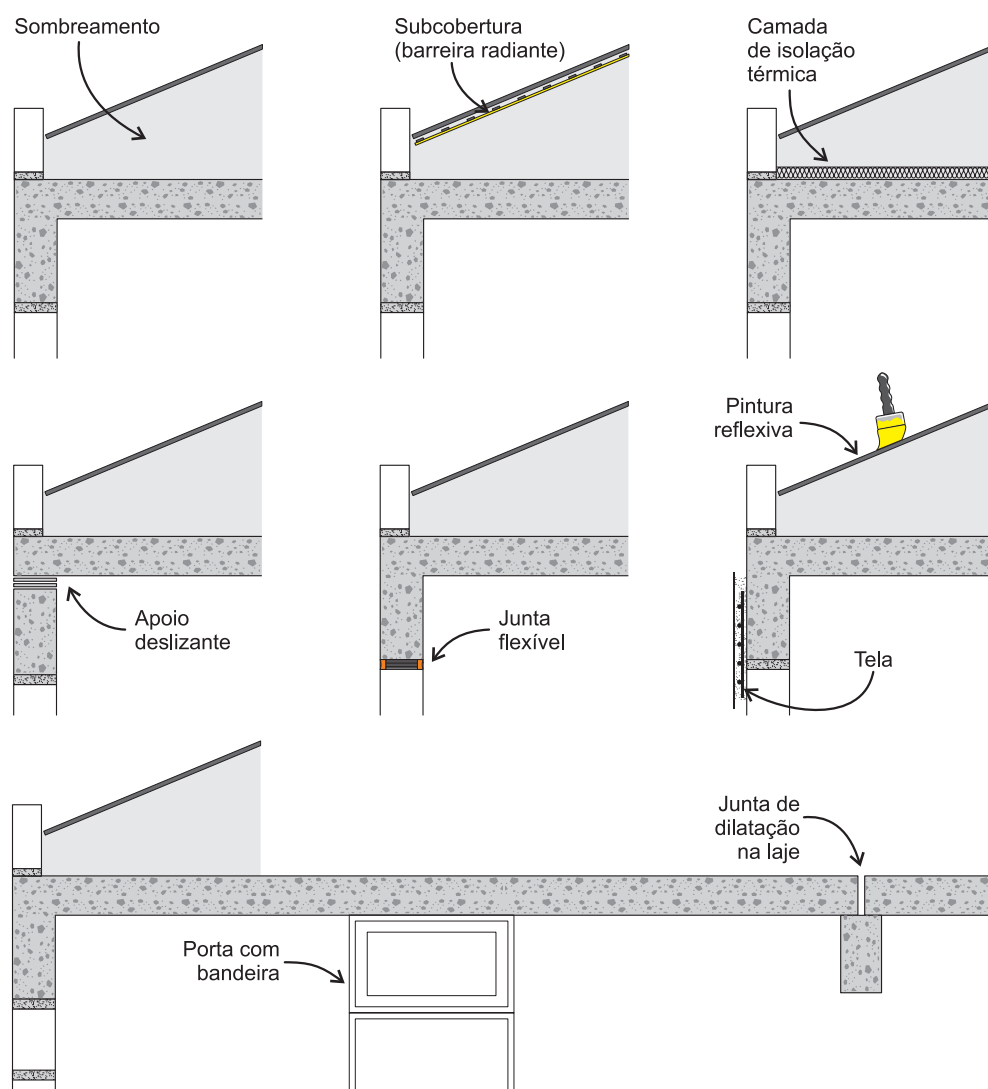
Soluções alternativas para o último pavimento: detalhes construtivos para minimizar risco de ocorrência de fissuras e destacamentos nas paredes.
